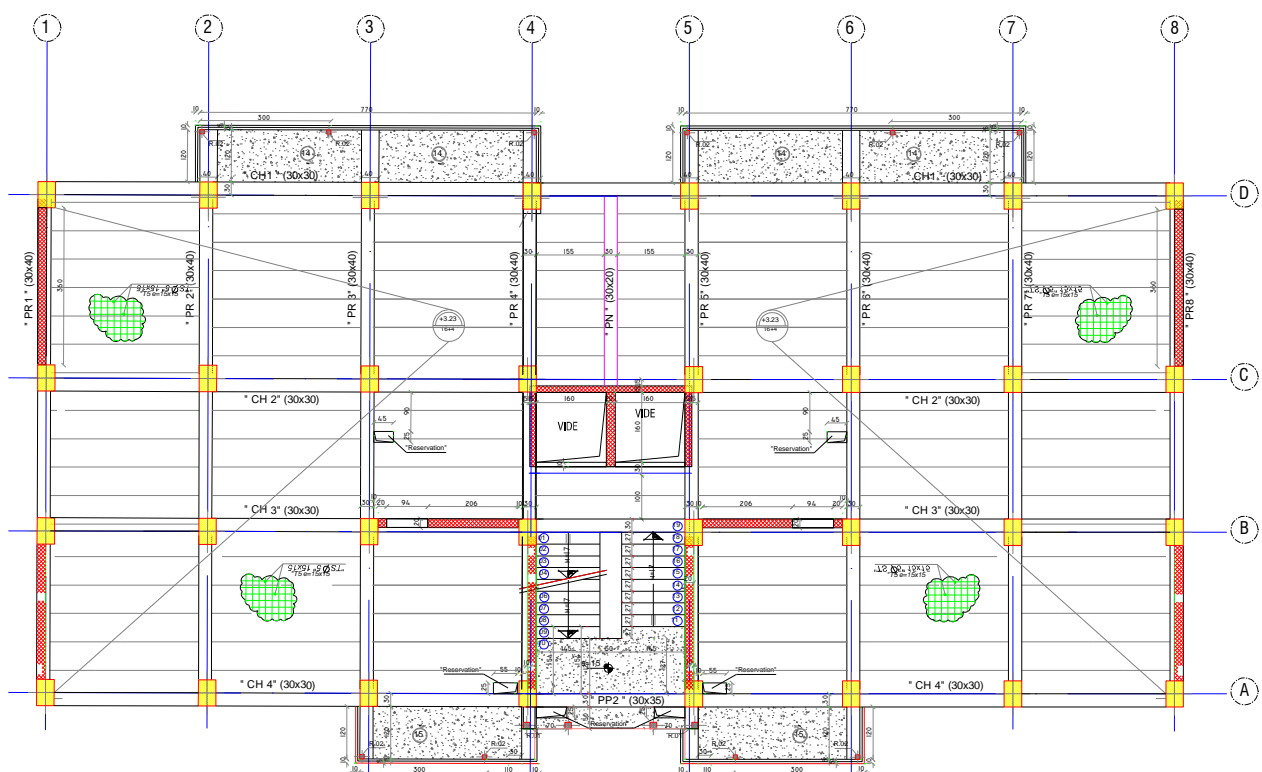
Plan de coffrage (Disposition des poutrelles).
